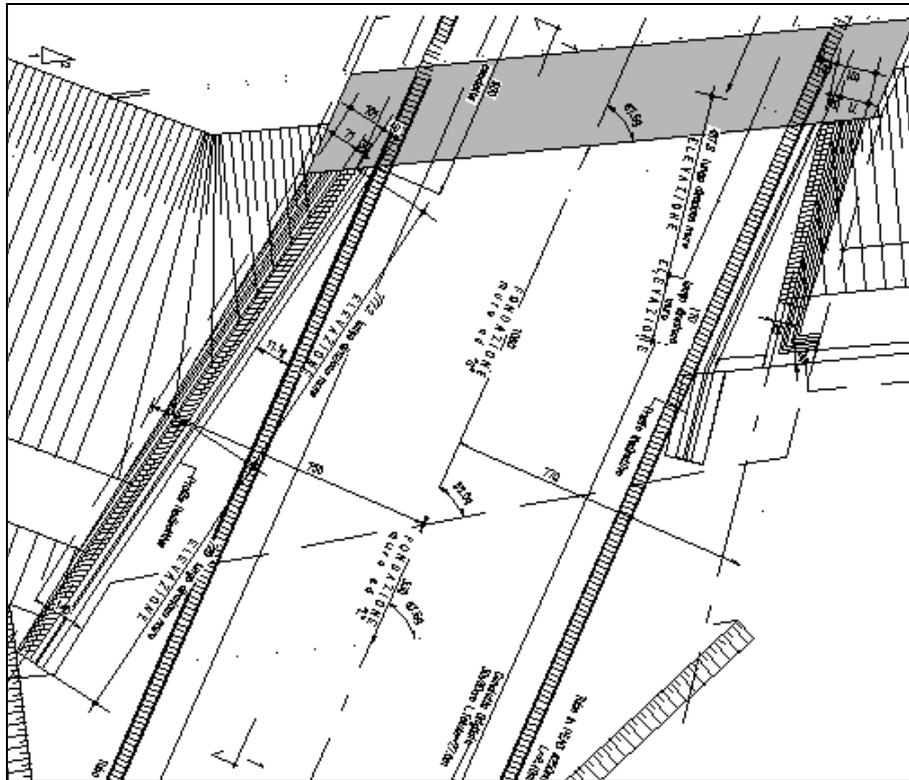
PARTICOLARE ALLARGAMENTO PLANIMETRICO DELLE ELEVAZIONI SUD
